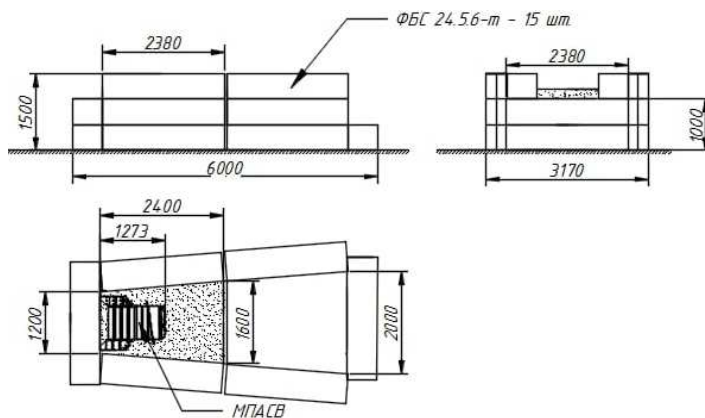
Схема стенда для испытаний ДО МПАСВ
